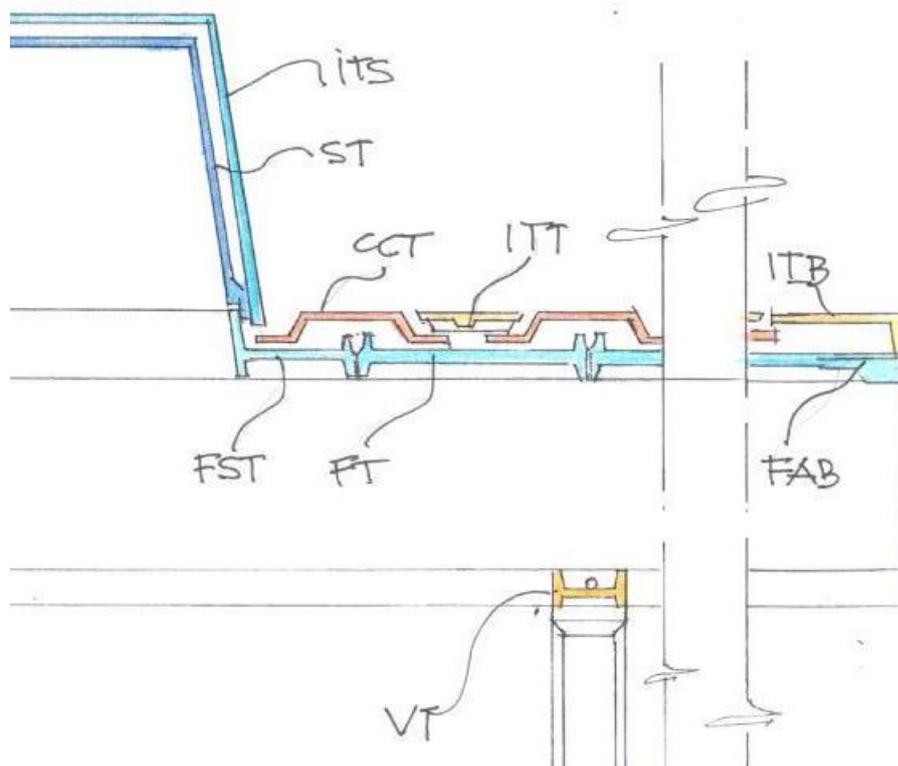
Detalhe lado externo módulo tipo. Fonte: Desenho do autor.
